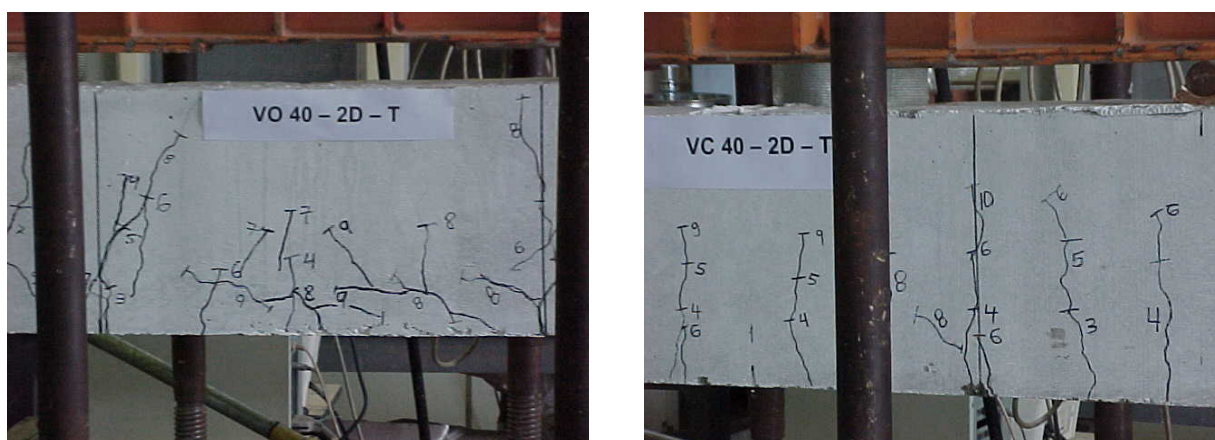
Vista lateral das vigas VO40-2D-T e VC40-2D-T após o ensaio.
